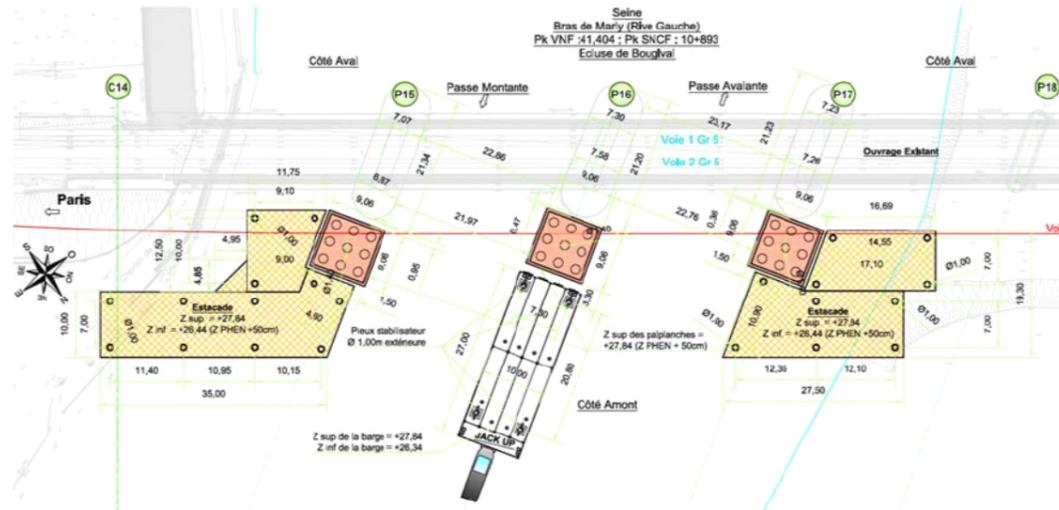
Implantation schématique des estacades en phase de construction des piles
